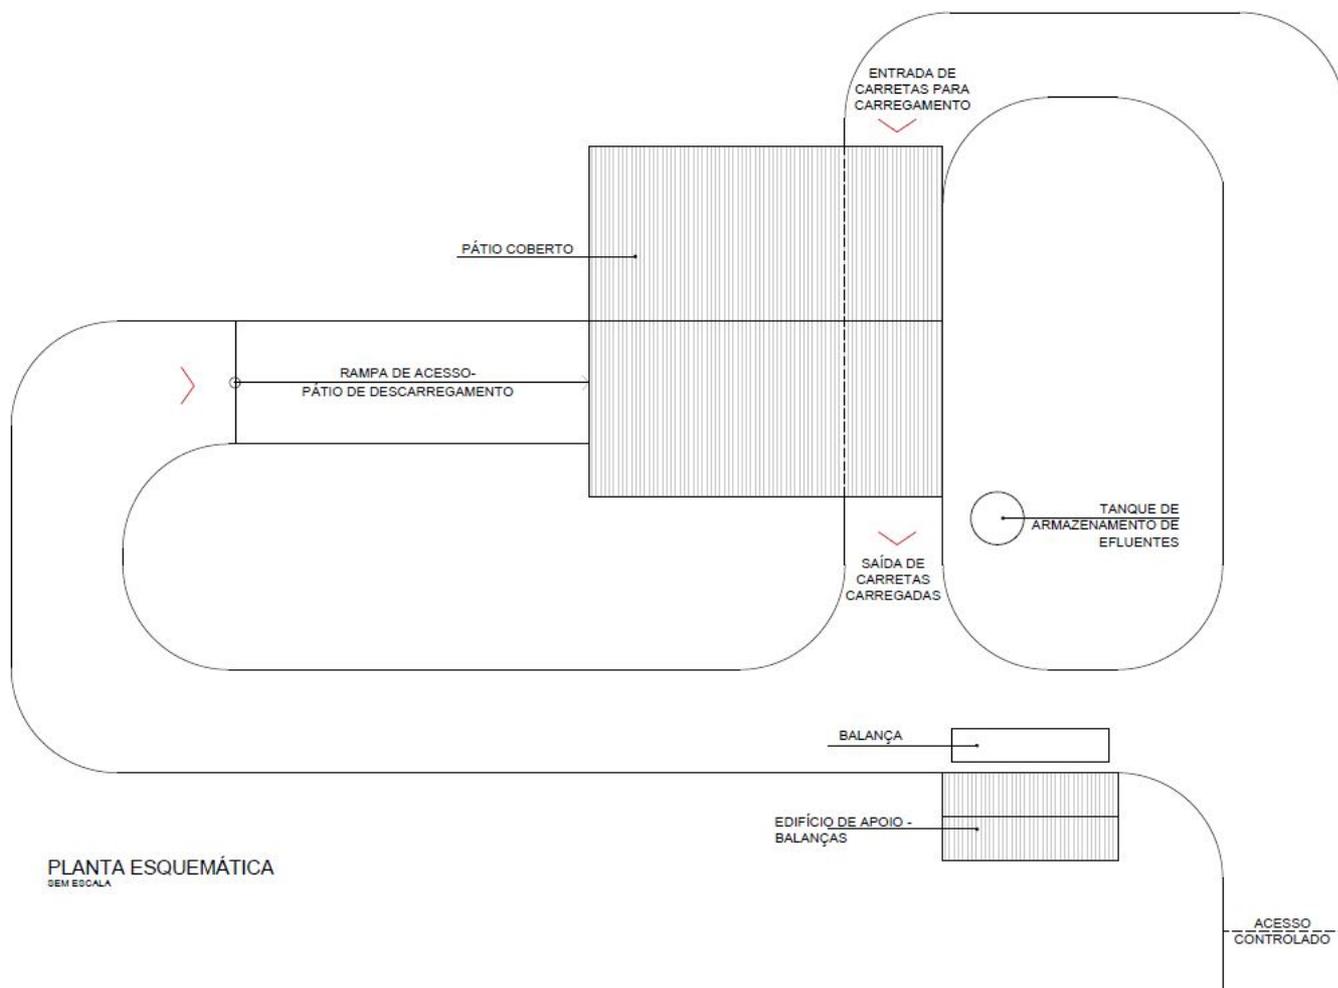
Planta esquemática de Estação de Transbordo. Sem escala.
